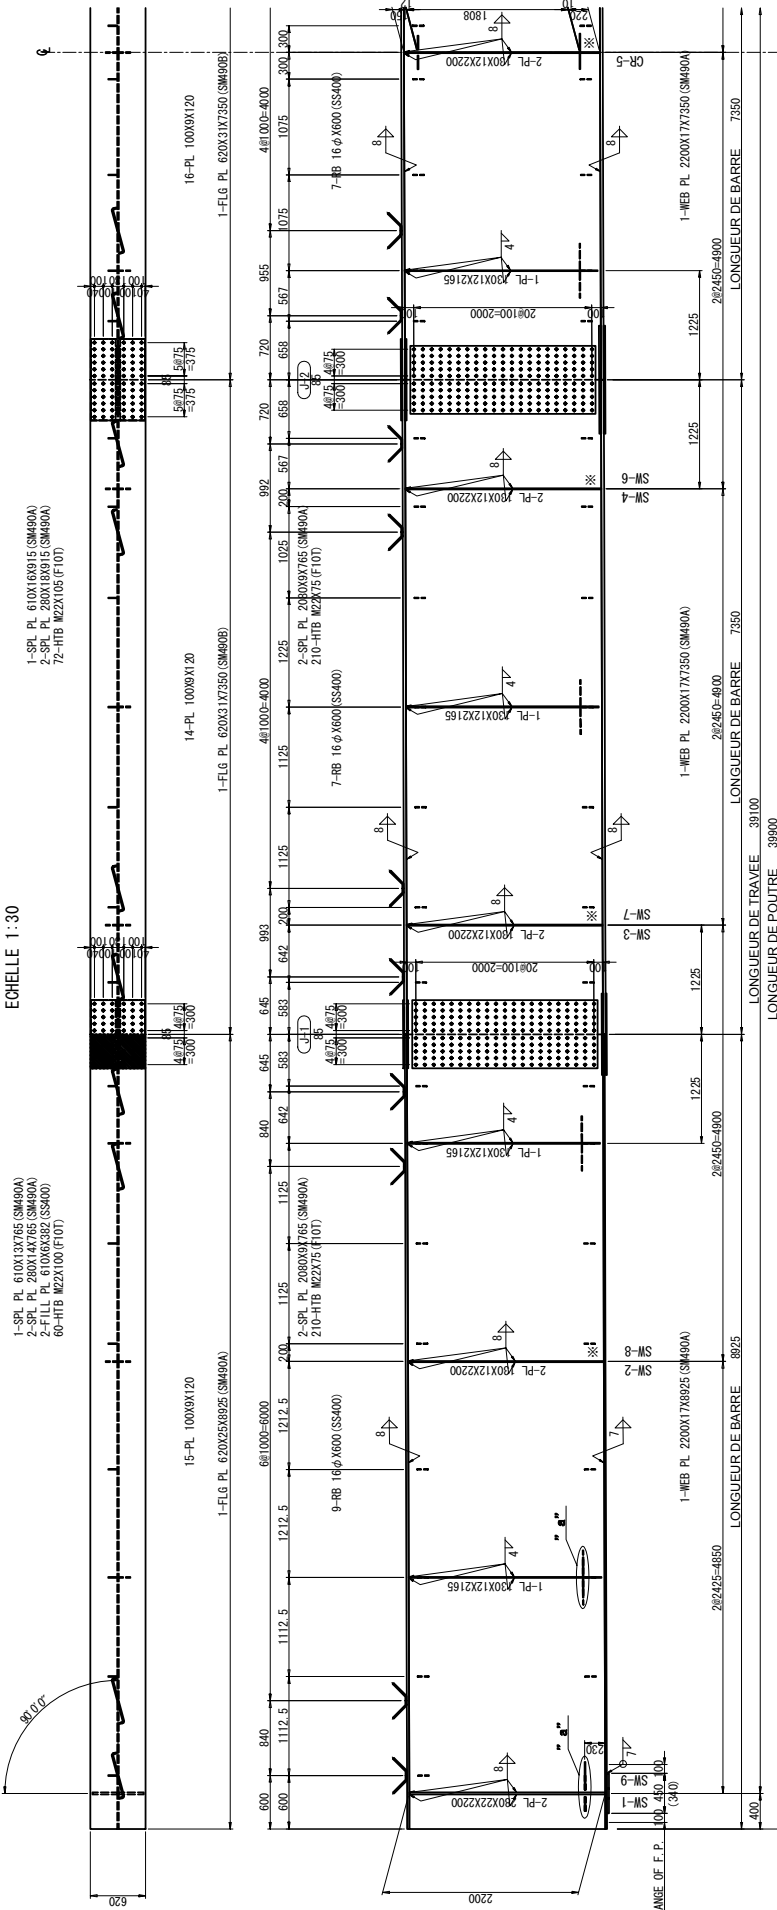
# DETAIL DES POUTRES METALLIQUES RINCIPALES G2 et G3
